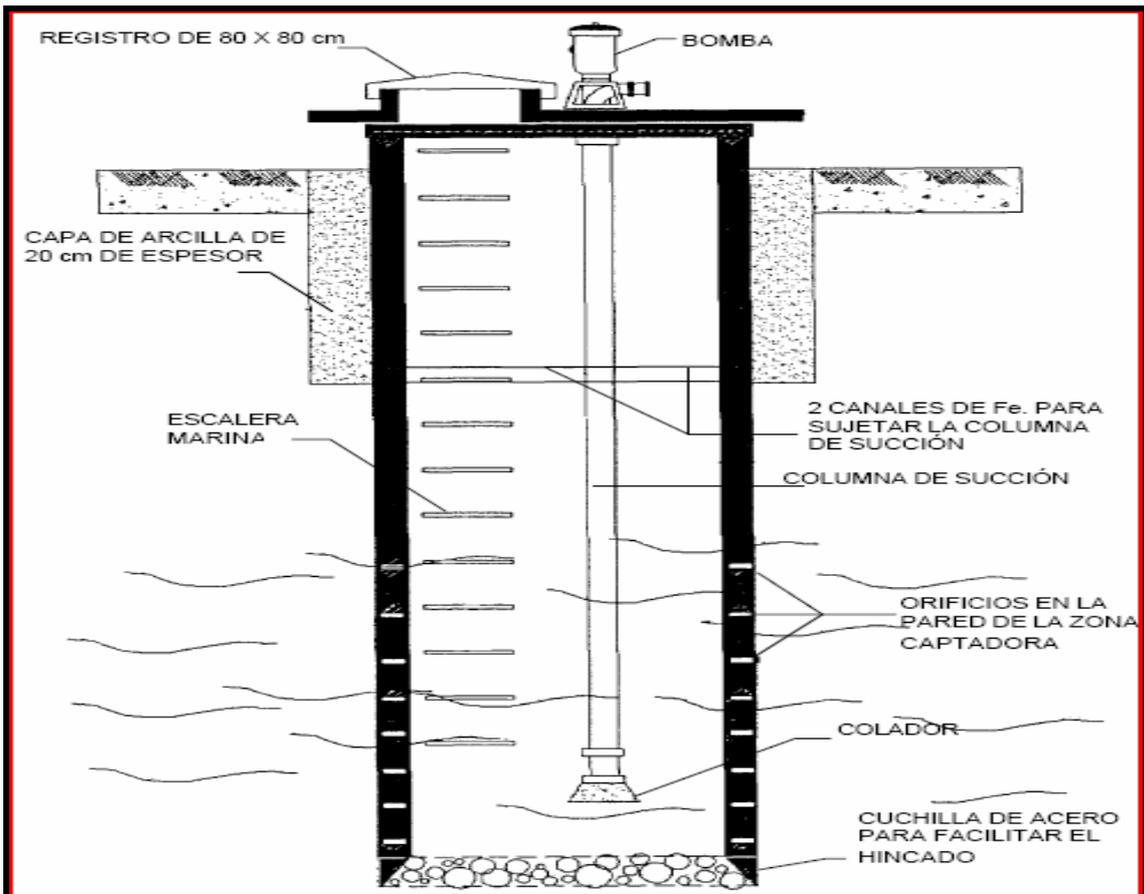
Obra de toma subsuperficial (a)-Pozo excavado
